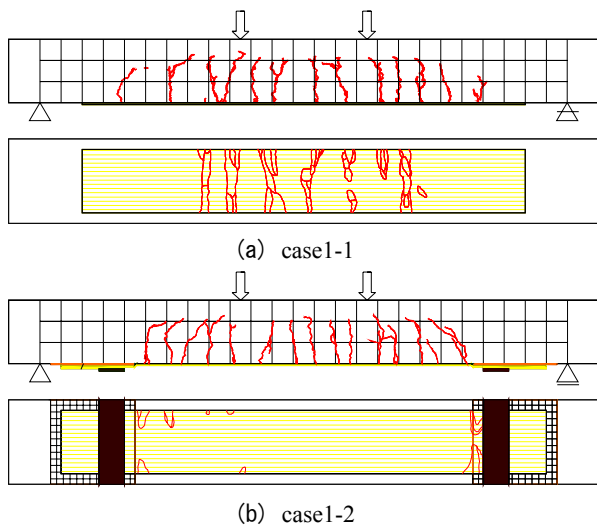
ひび割れおよびアラミド繊維シート剥離状況 (200万回載荷後)
